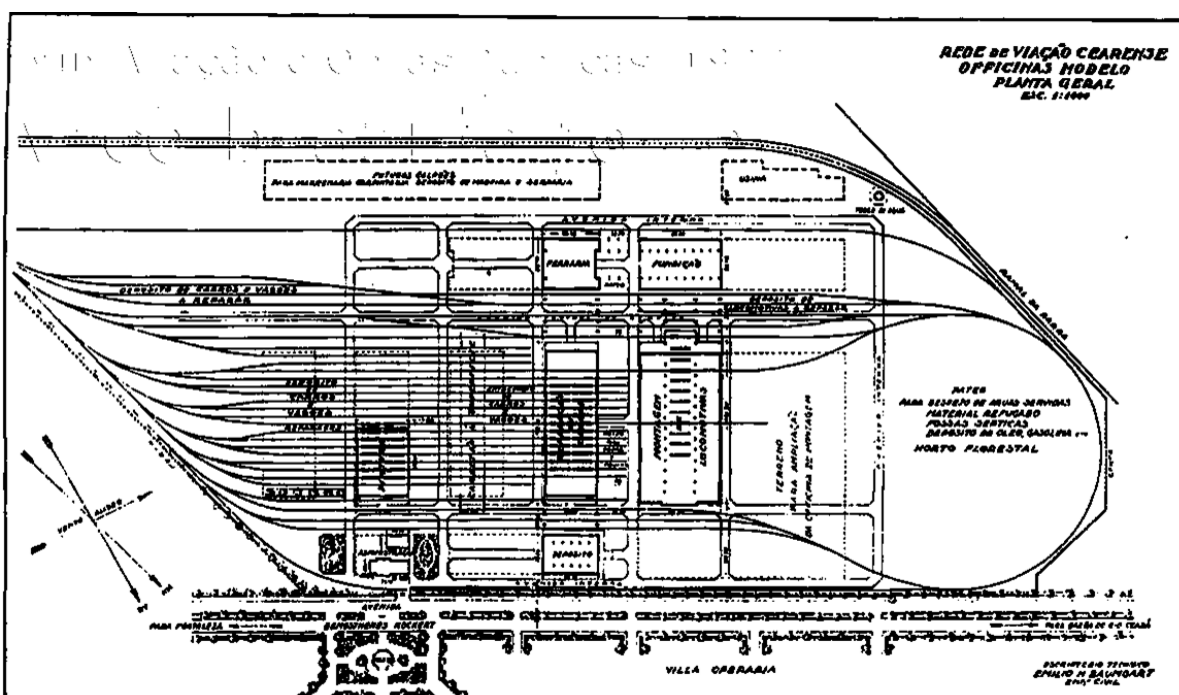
Planta Geral das Oficinas. Fonte: Acervo RFFSA.
